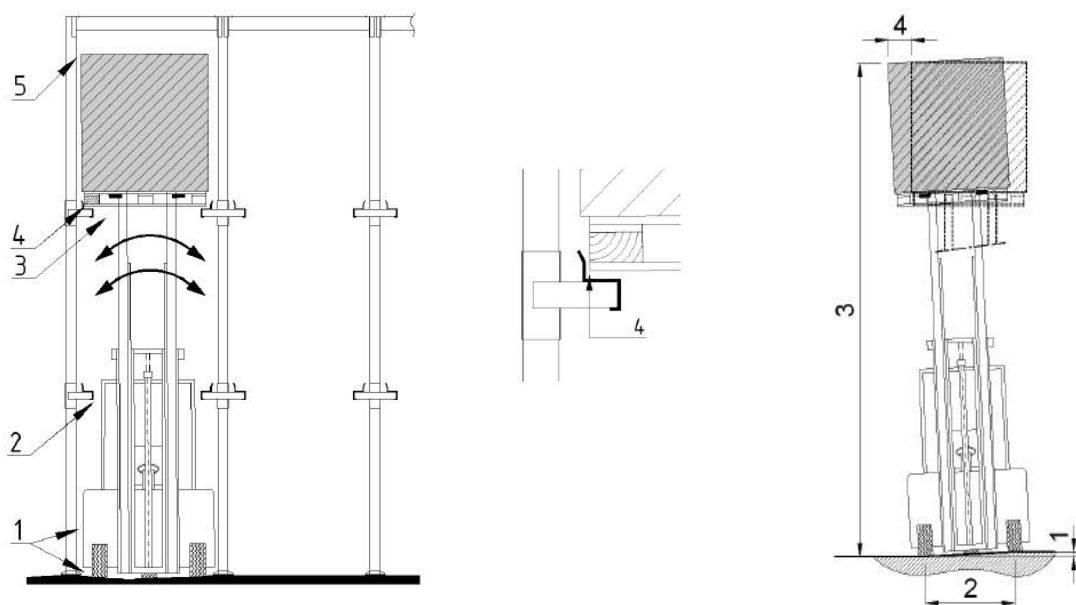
Planarità della pavimentazione e deformabilità del carrello nel drive-in
